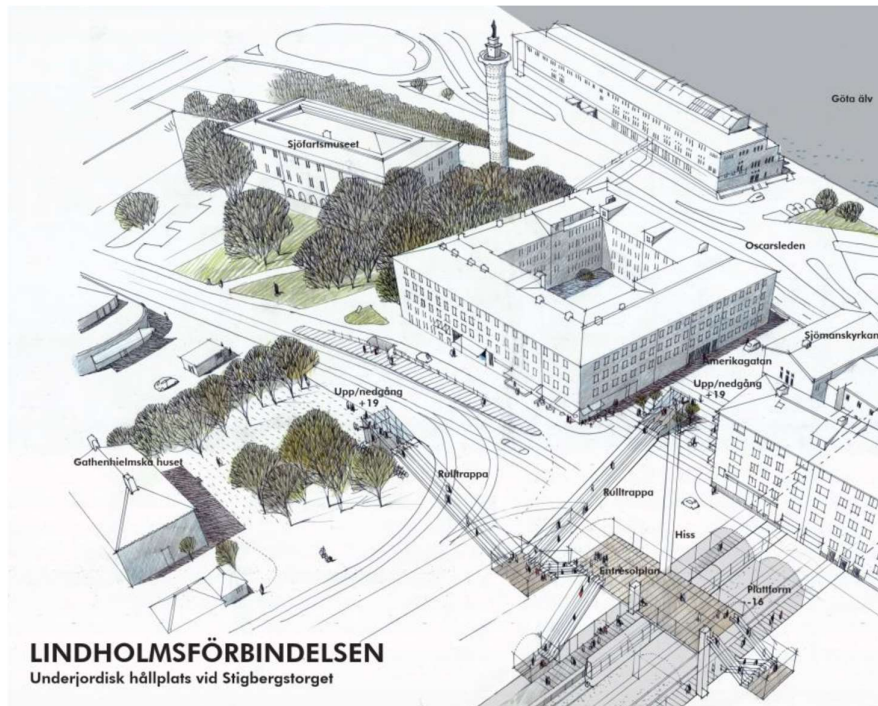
Alternativ Tunnel. Översikt som visar tänkt läge för tunnelpåslag på Stigberget¹². Den slutliga utformningen är inte fastlagd.
